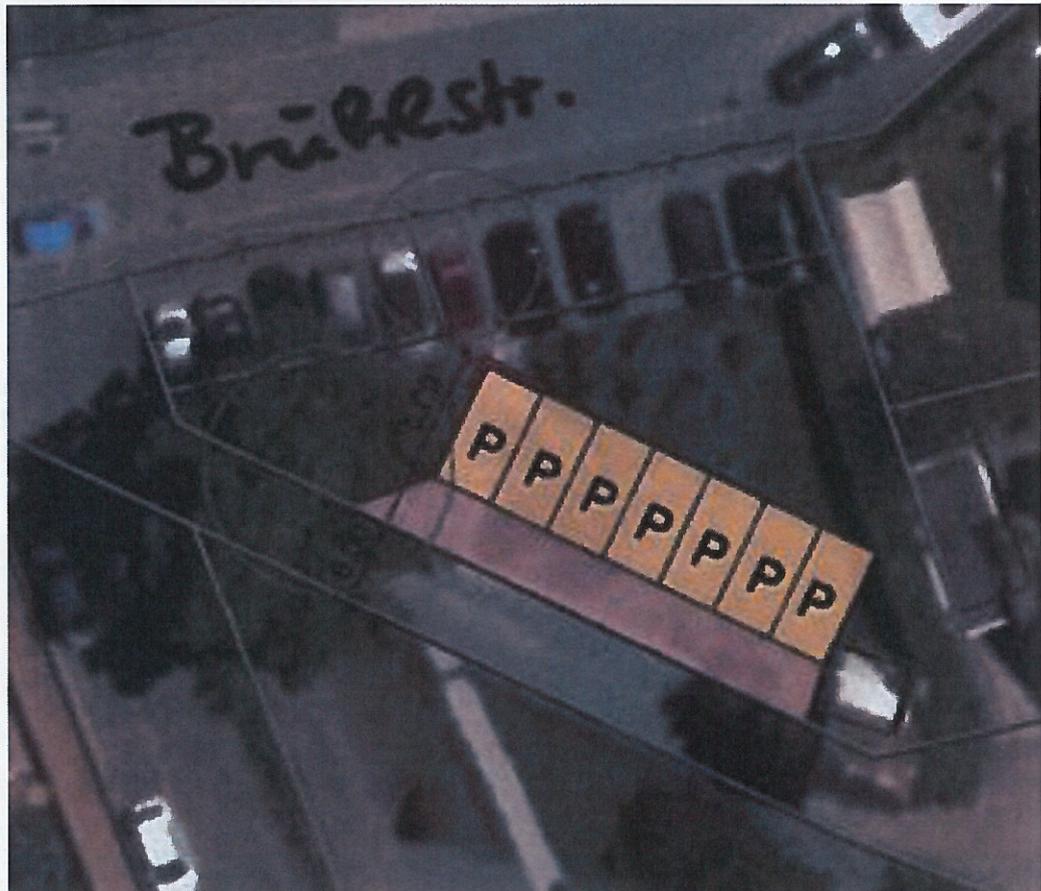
Parkierungsmöglichkeiten, Quelle: Fichtner Consulting, Stand 012.02.2019
